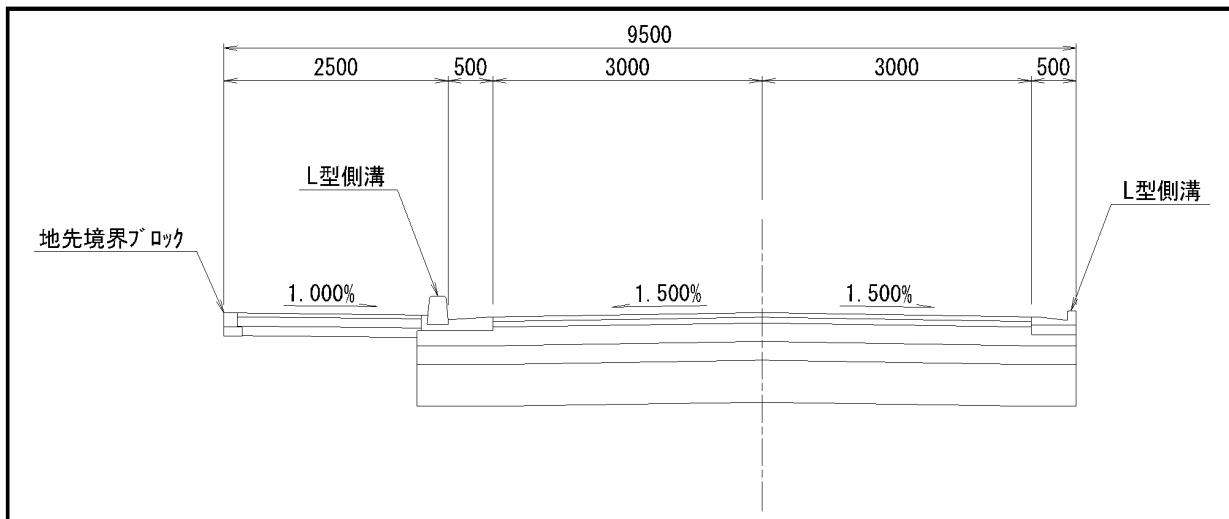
(4) 道路の標準断面図（区画道路 9.5-1, 2 号線 幅員 9.5m）
